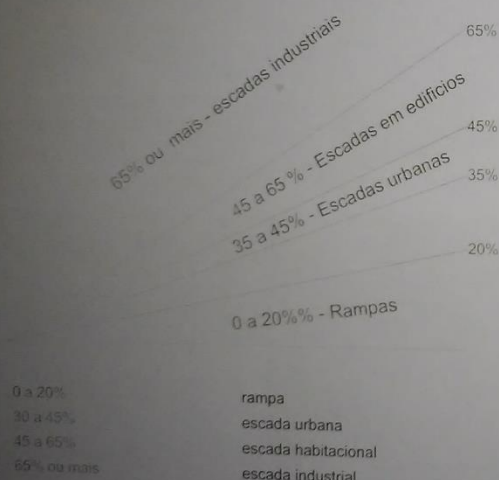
Inclinações recomendadas para escadas e rampas.
